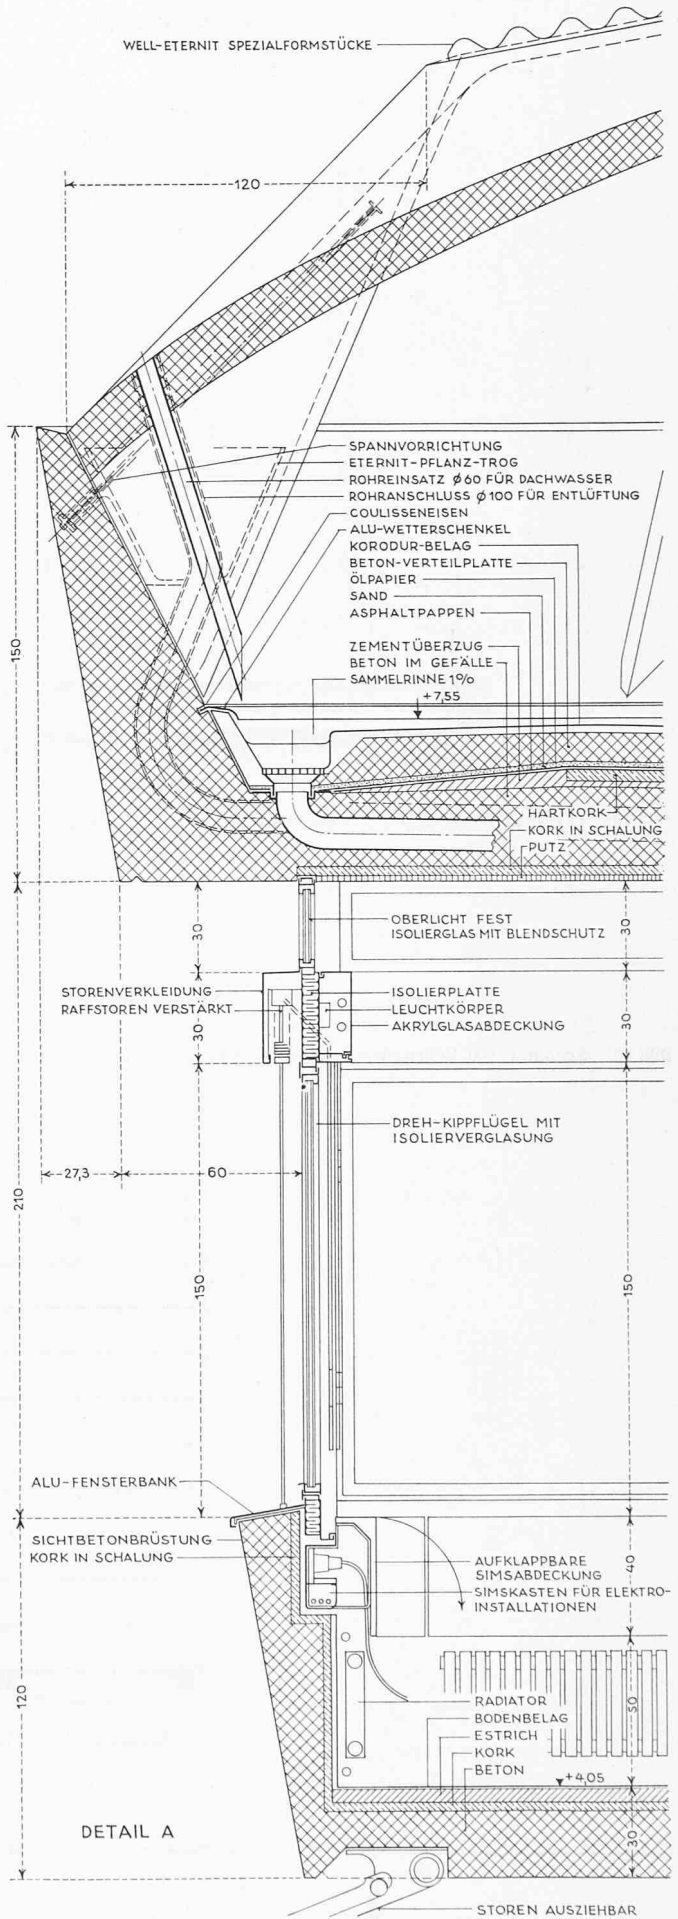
Gesamtschnitt durch das Ladengeschoss
